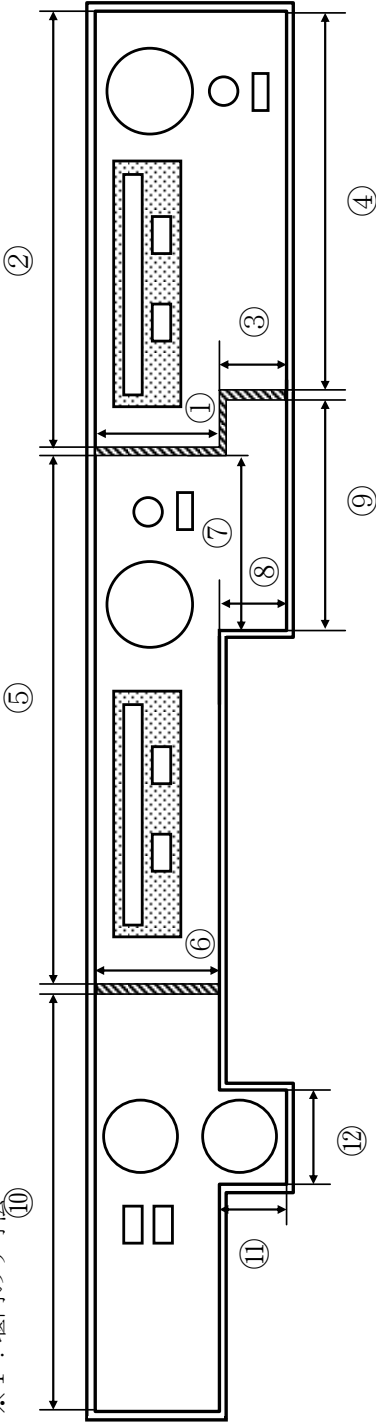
建屋内 RO 循環設備の漏えい拡大防止 堰配置図
